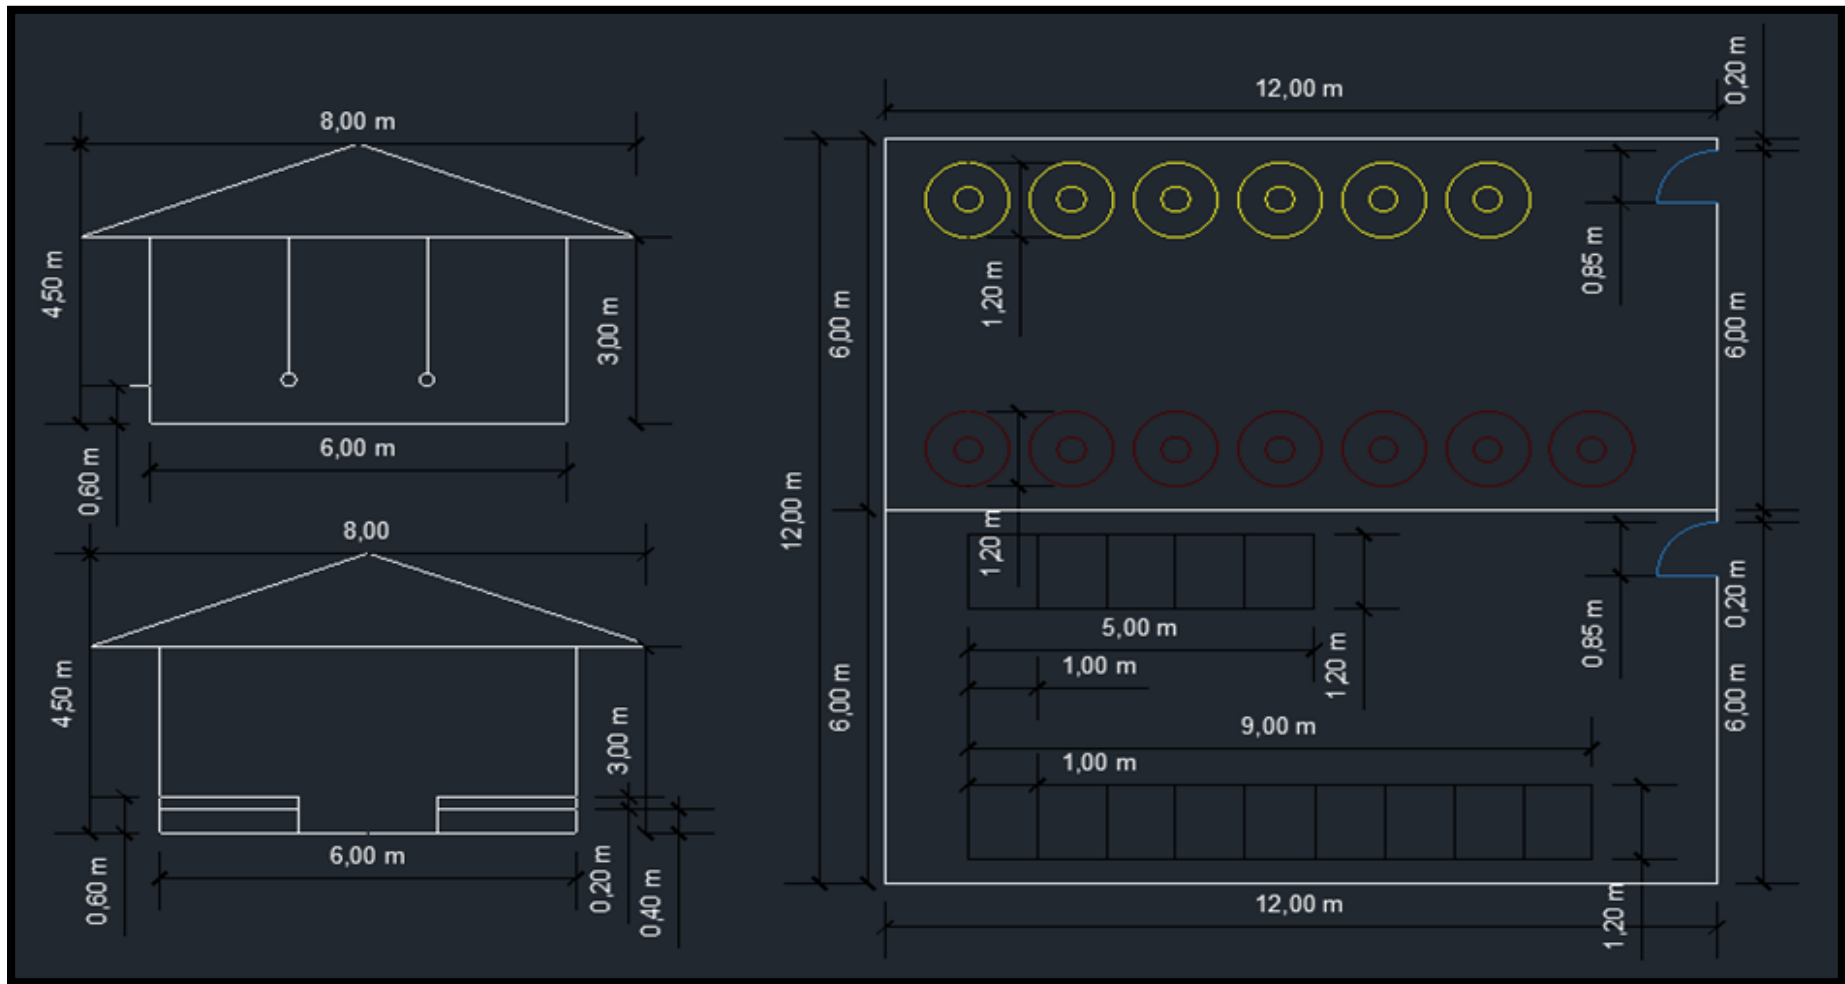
Diseño de las estructuras para la crianza de las aves de corral (vistas de alzado y planta respectivamente)
